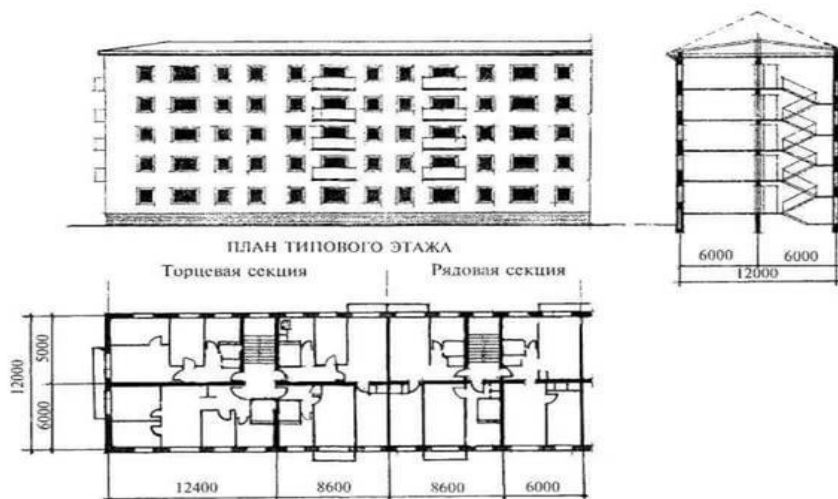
План, фасад, разрез многоквартирного жилого дома
